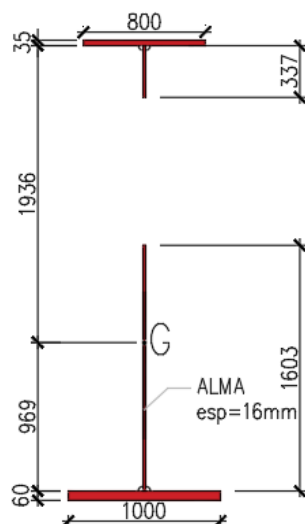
Dimensões da secção metálica efectiva - zona do vão central [mm]
